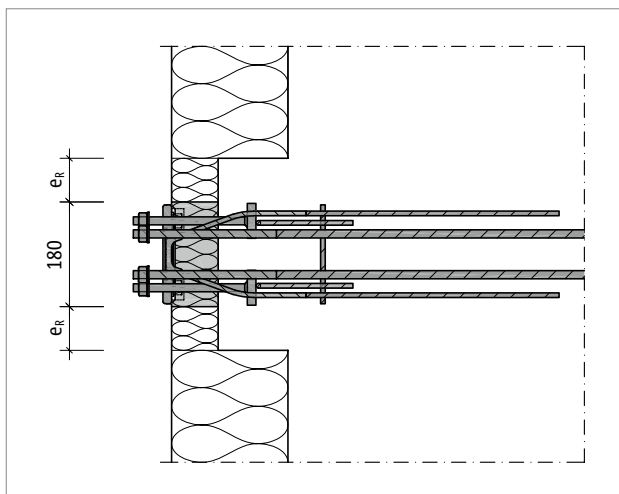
Schöck Isokorb® T Typ SKP: Randabstände
